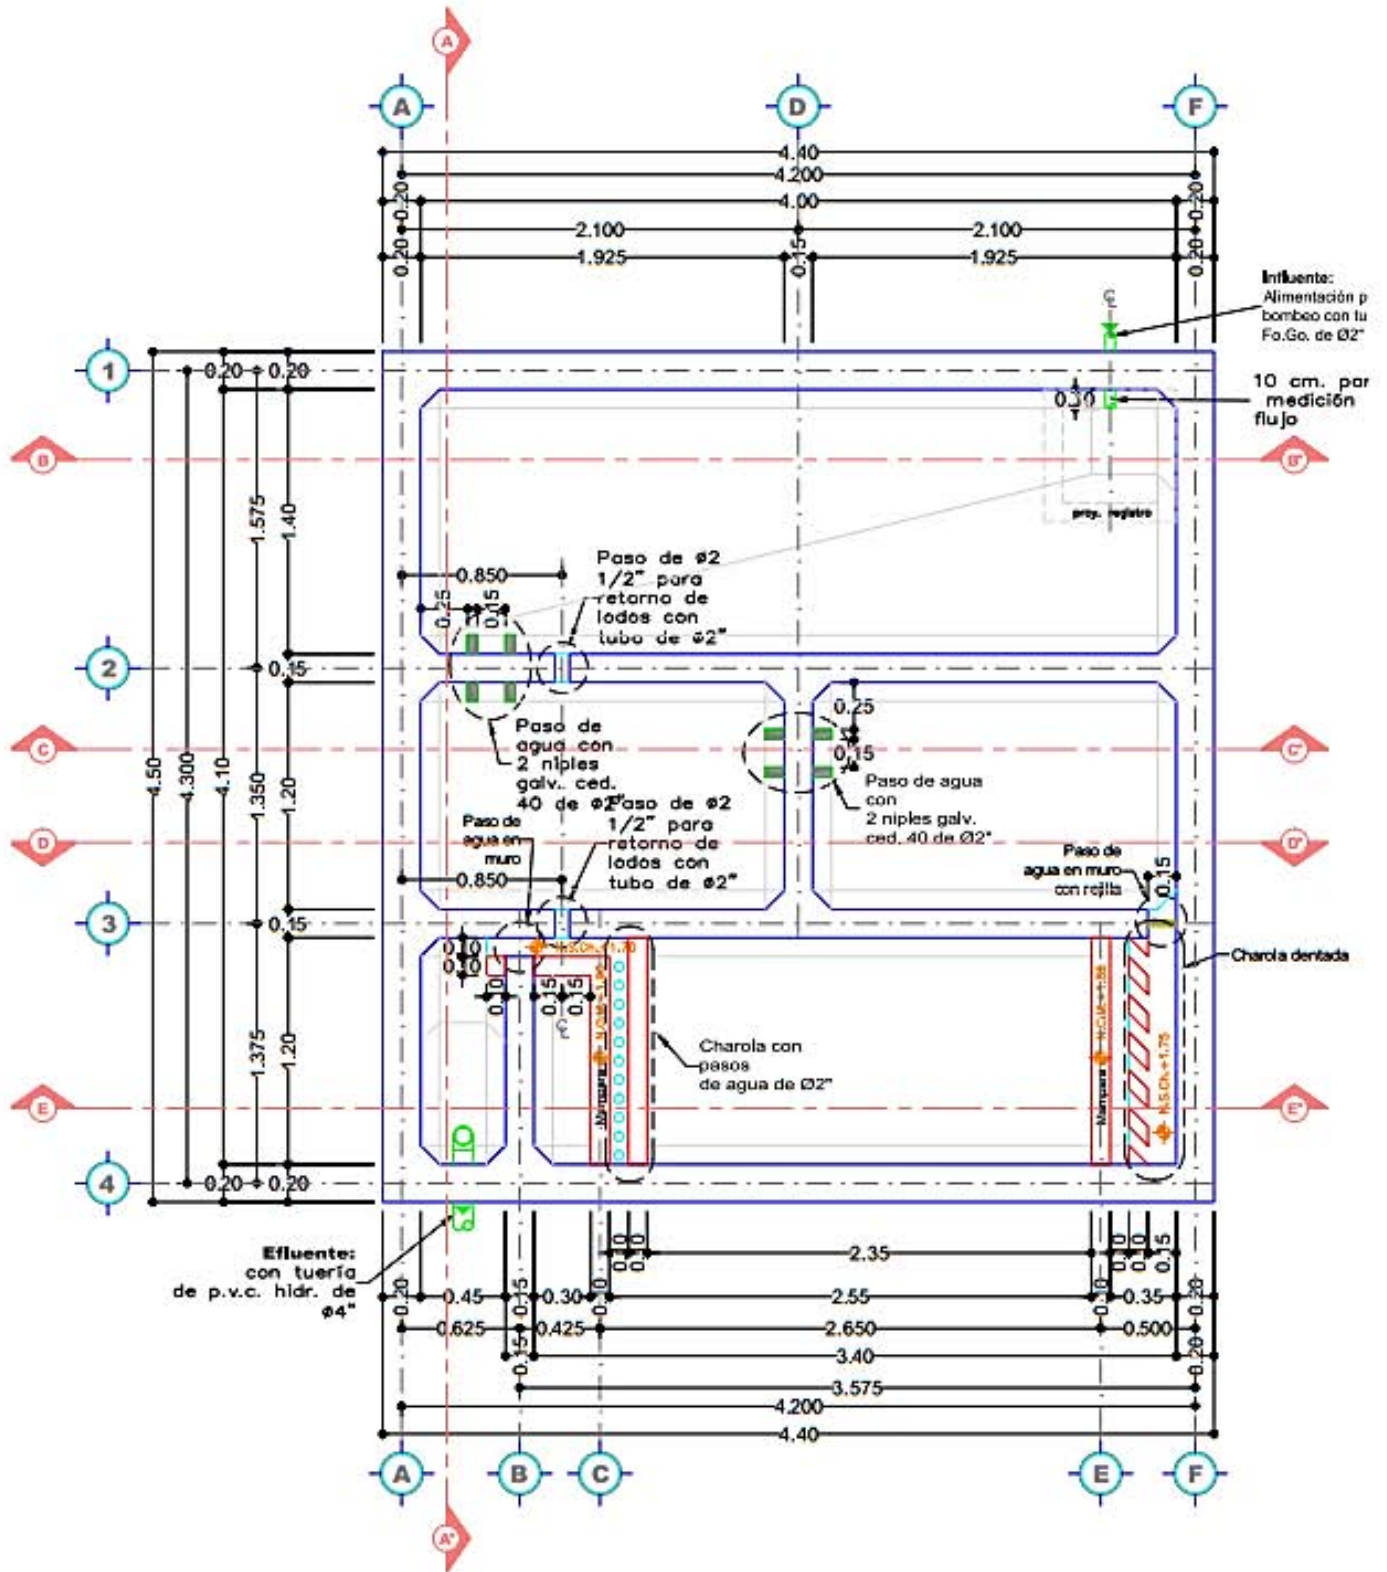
Vista en planta de la planta de tratamiento de aguas residuales
